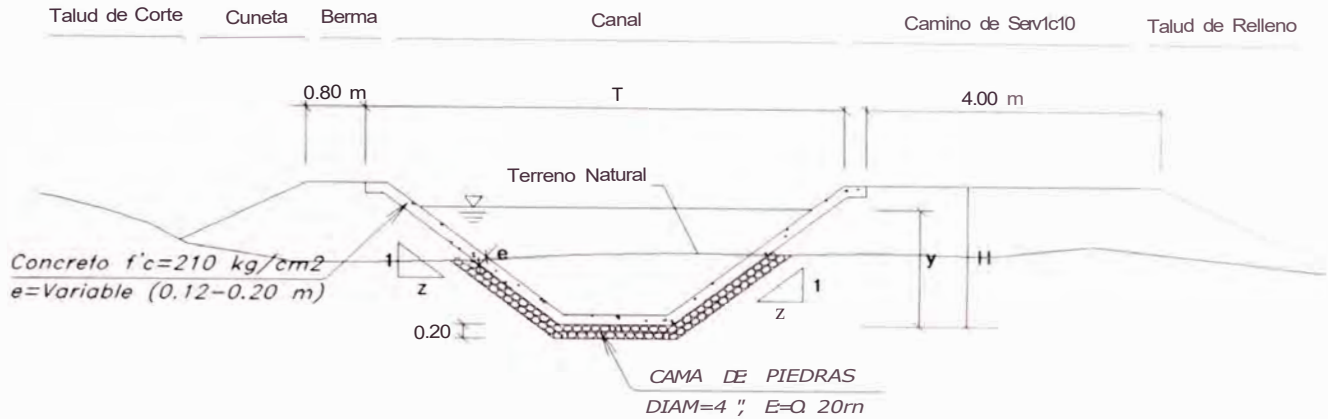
Sección Típica de Cama de Piedras en Relleno del Terreno en el Canal Trapezoidal
